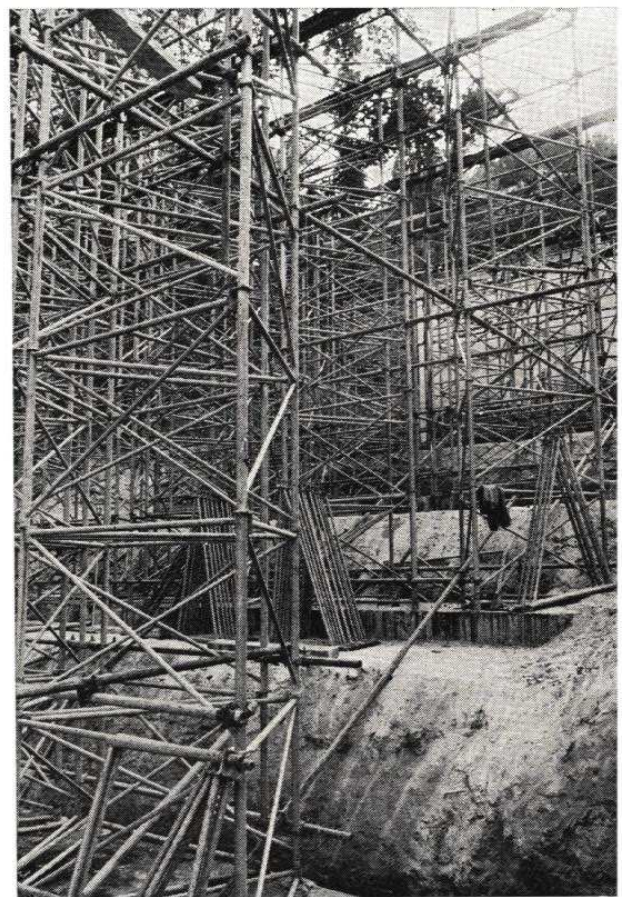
Étalement : fondation des dalles en béton préfabriquées et servant ultérieurement de dalles de transition.
